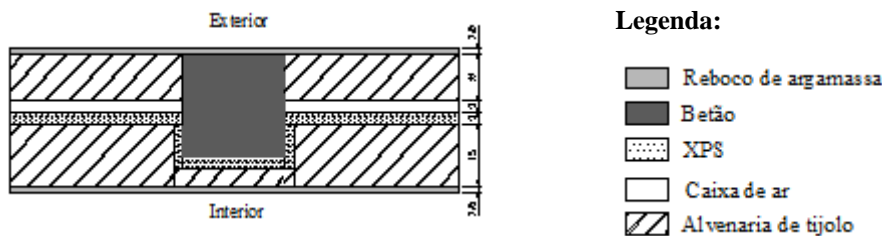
Pormenor construtivo do pilar na parede exterior revestido com XPS
